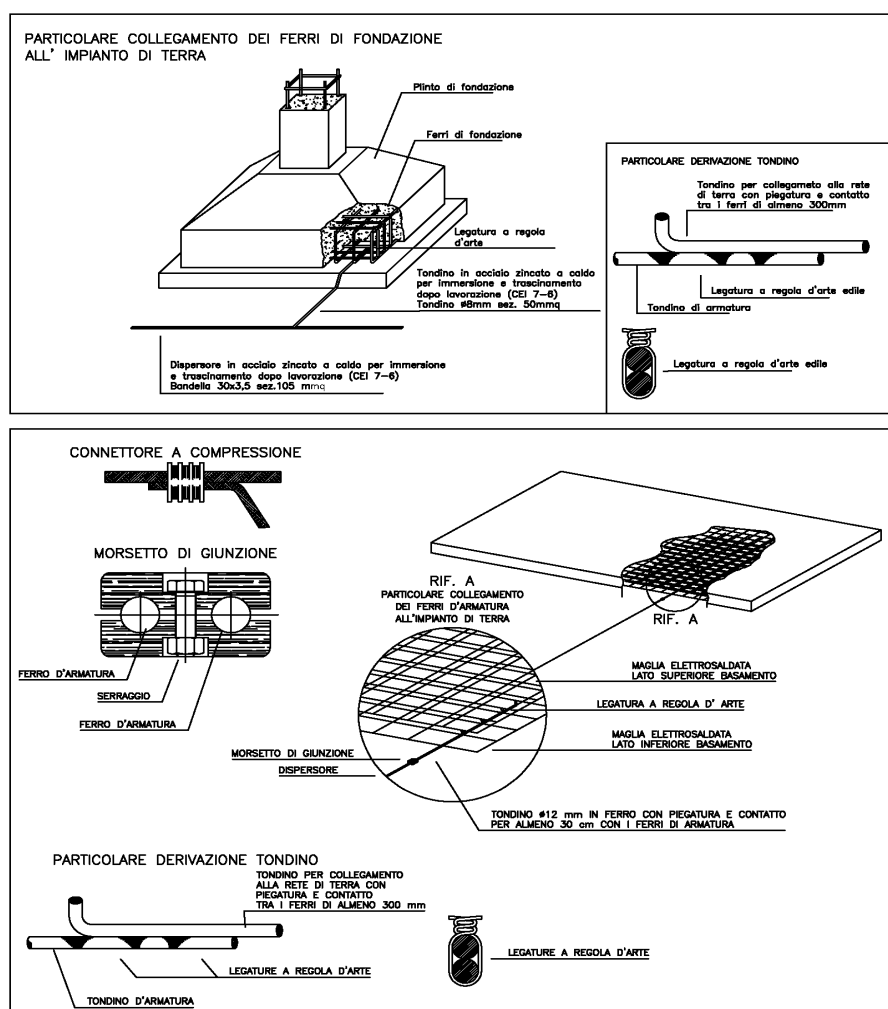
PARTICOLARE DEL COLLEGAMENTO DEI FERRI DI FONDAZIONE AL SISTEMA DI TERRA
